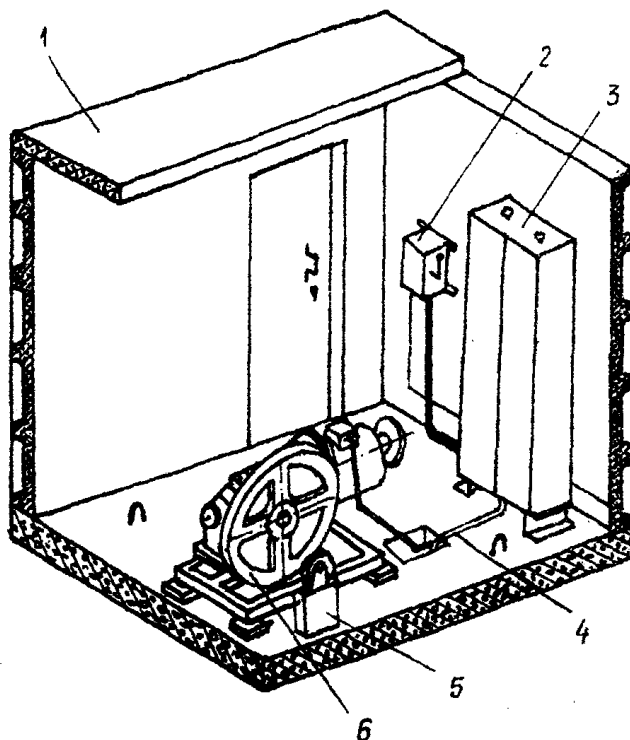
Объемное машинное помещение, оснащенное лифтовым оборудованием:
